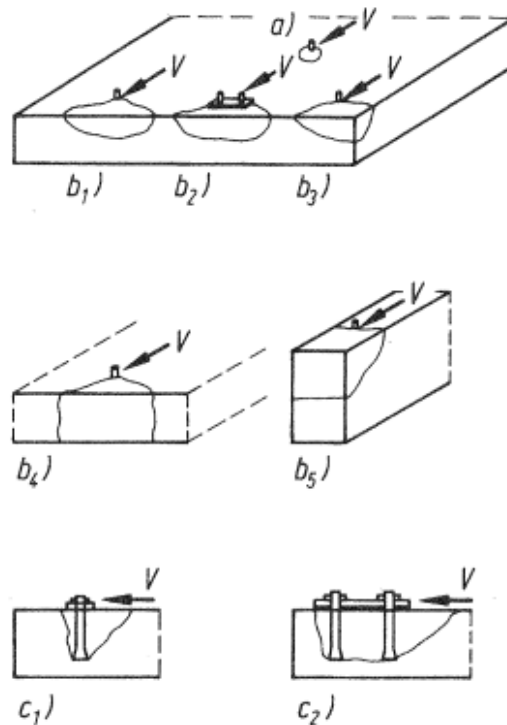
Versagensformen von Befestigungen unter Querlast. A: Stahlversagen, B: Betonkantenbruch, C: Rückwertiger Betonausbruch. [1]
